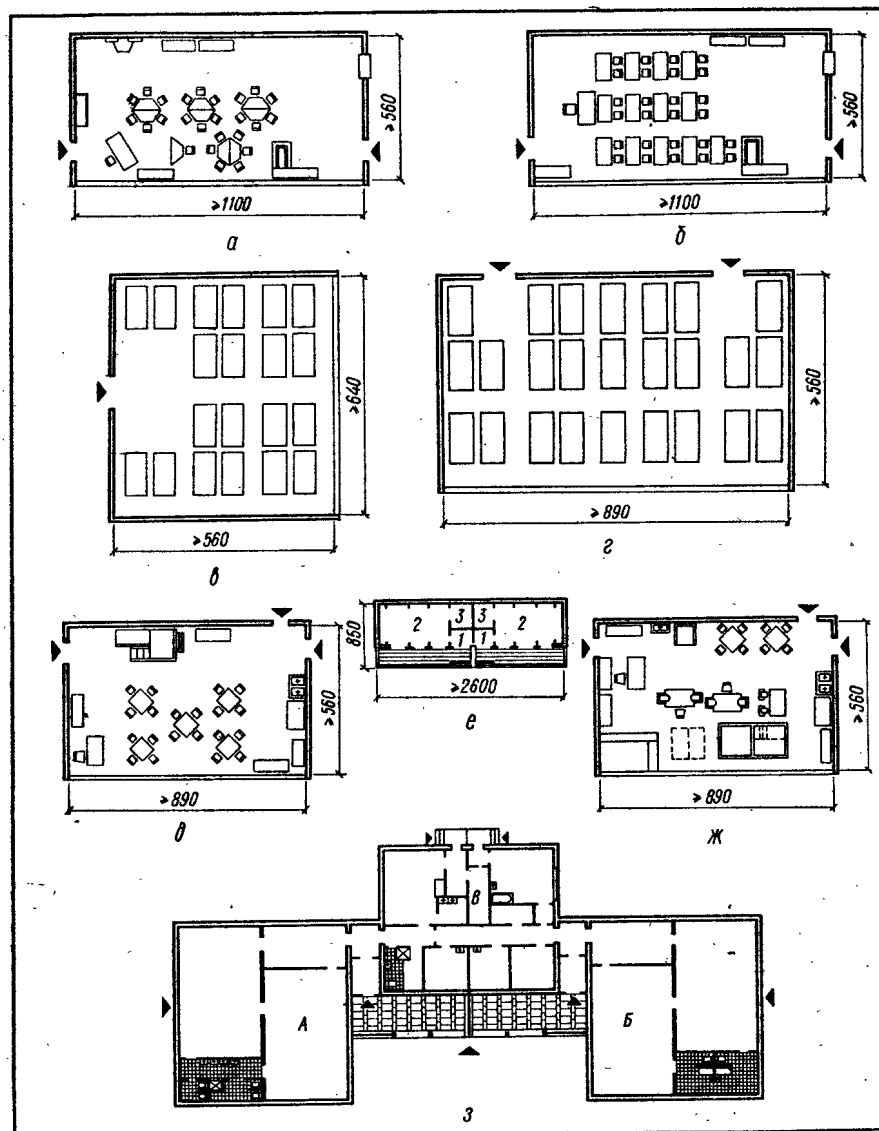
Элементы планировки помещений ясельной, и дошкольной групп:
